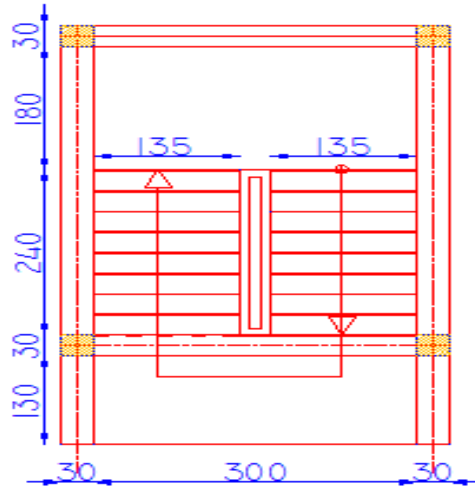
vue sur plan et le schéma statique de l'escalier.
